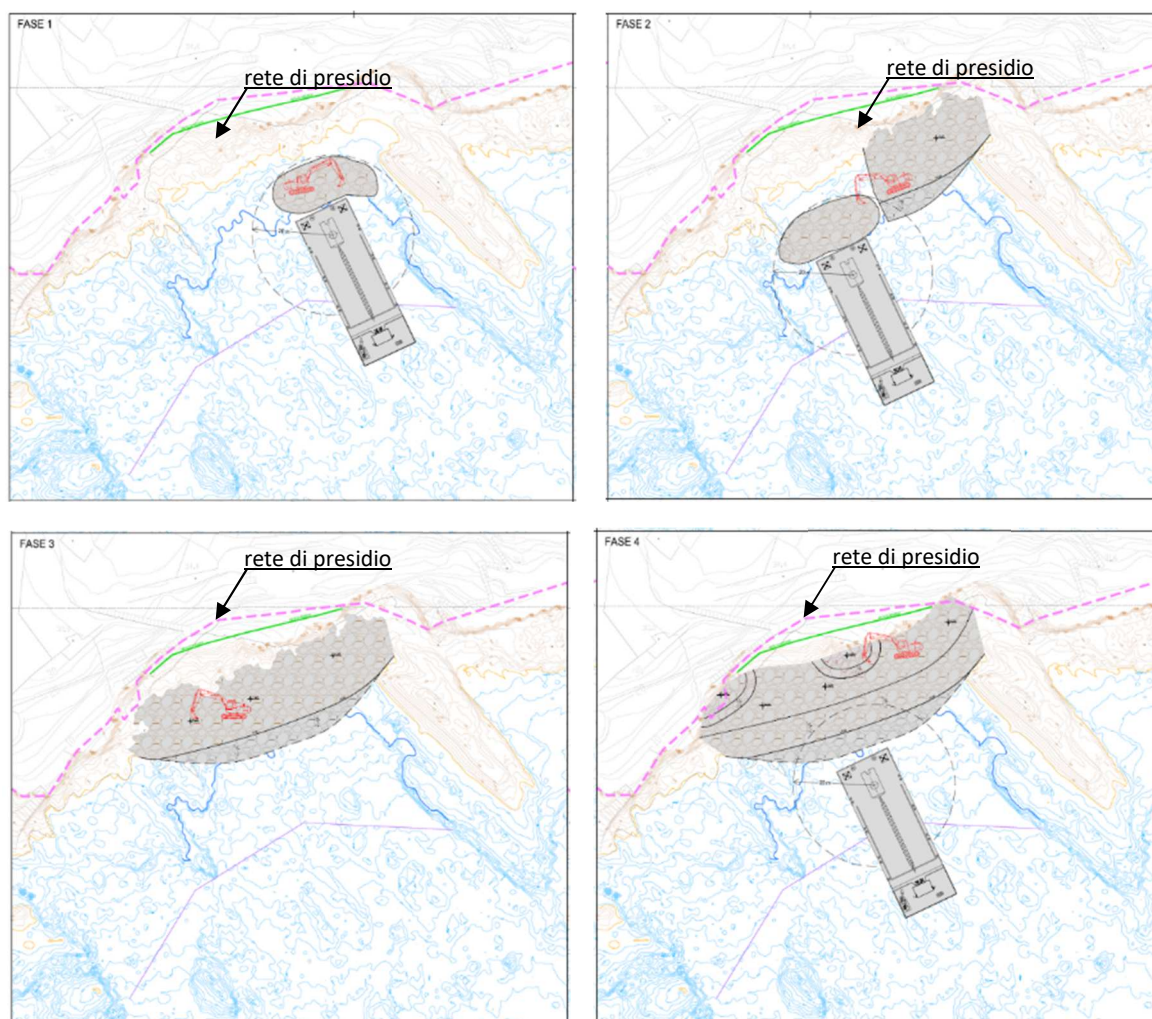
stralcio grafico delle fasi di lavoro della rete di presidio (v. disegno D08)
